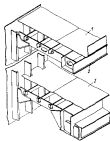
Боковые карнизные, служащие опорой для листов кровли двуполубного сечения с широким раскрытием галуба
